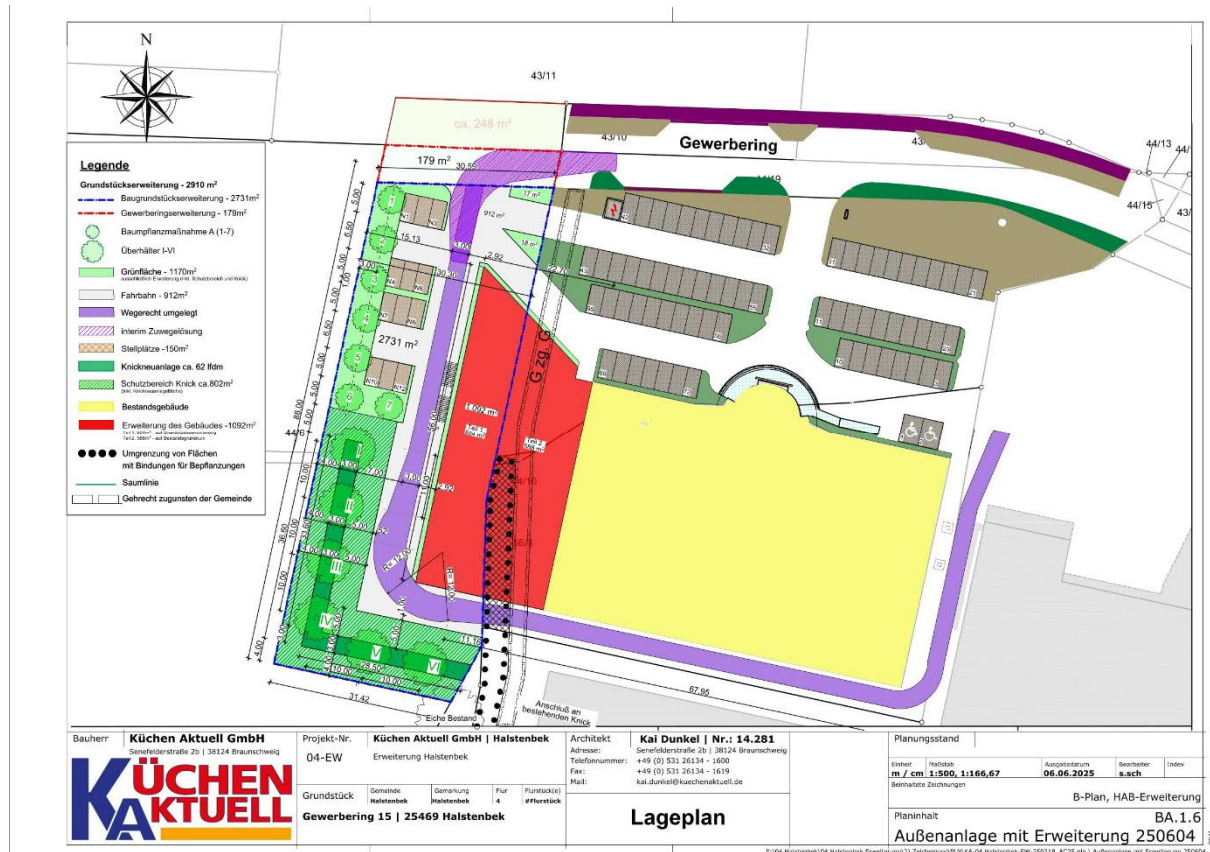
Darstellung der geplanten Außenanlagen mit Erweiterungsbau
